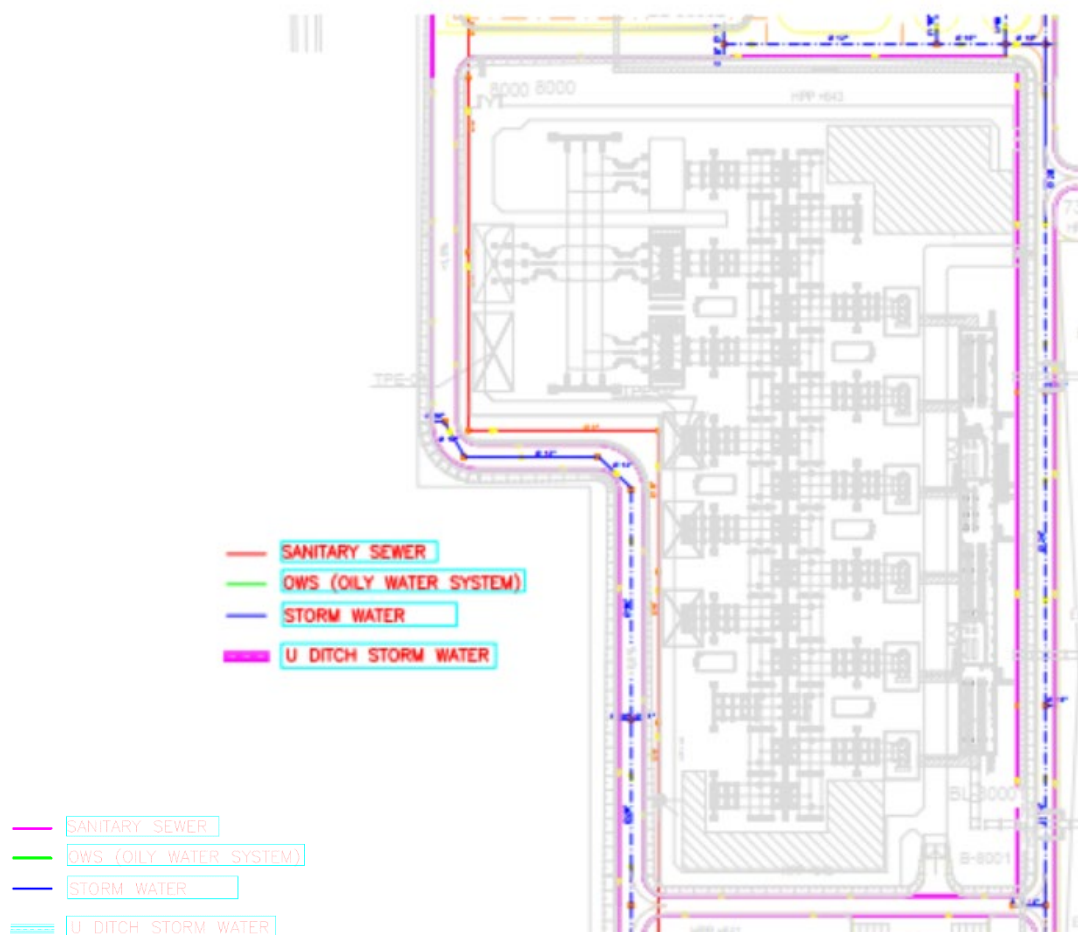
Red de drenajes de la Subestación integrada con la de la Planta de Hidrógeno
